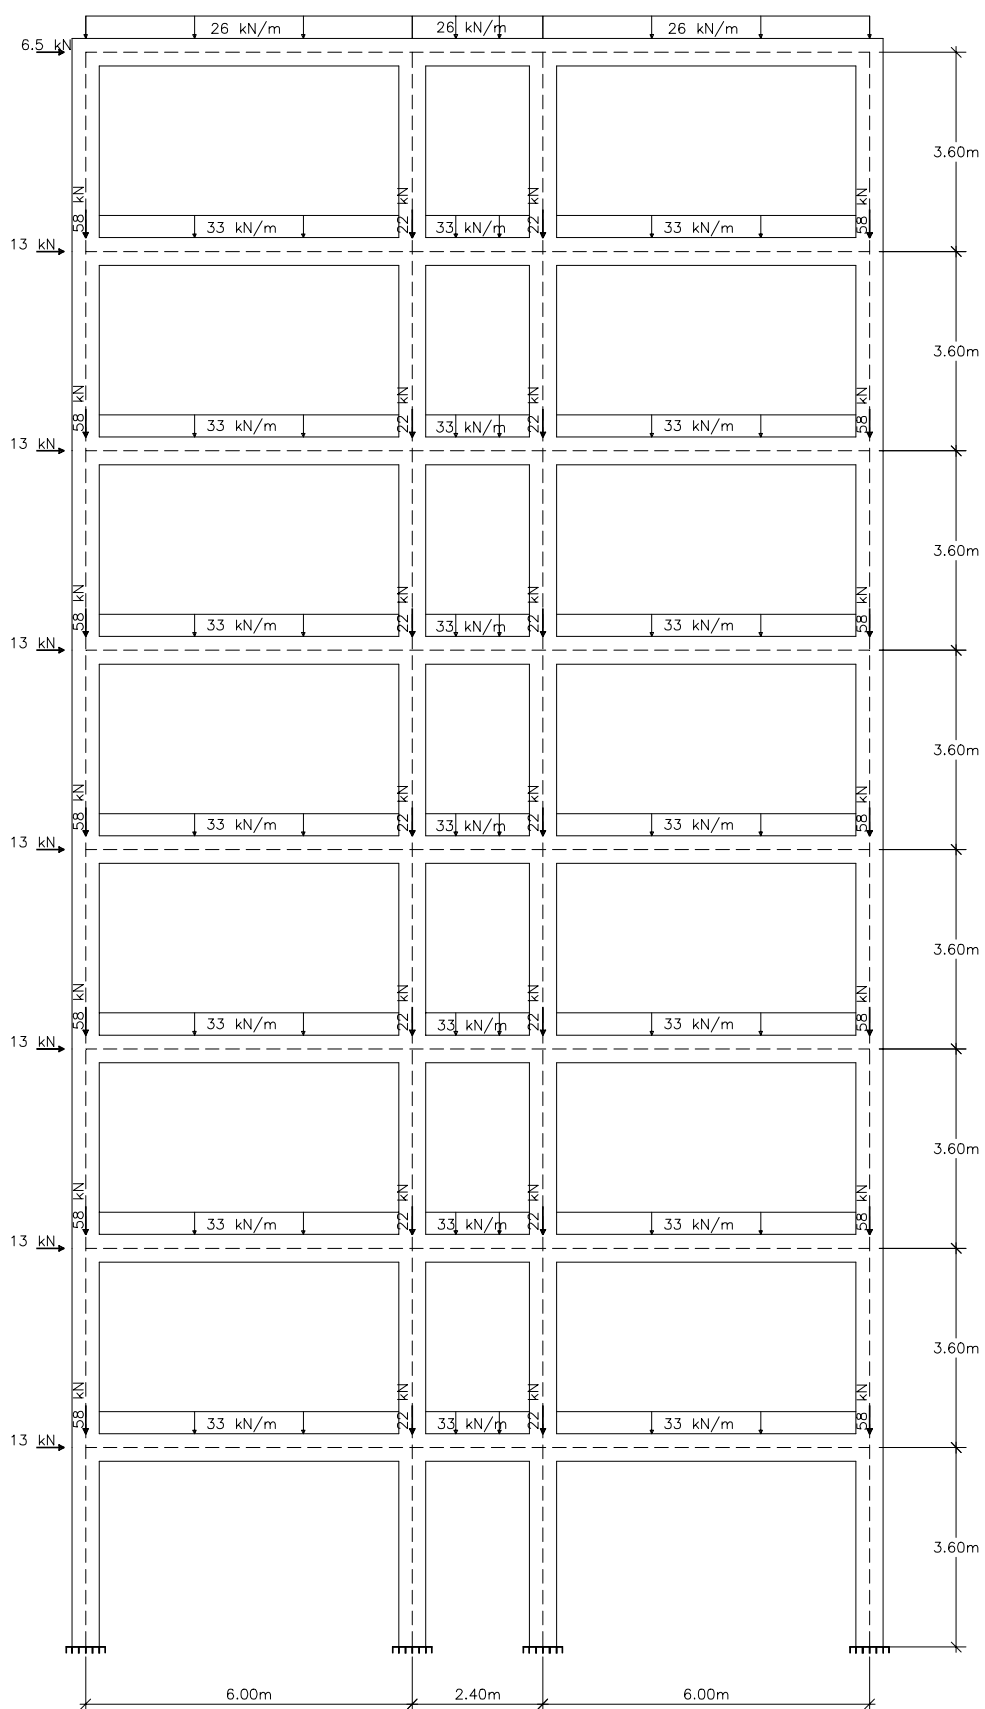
Geometria do pórtico pertencente ao edifício de 8 pavimentos
